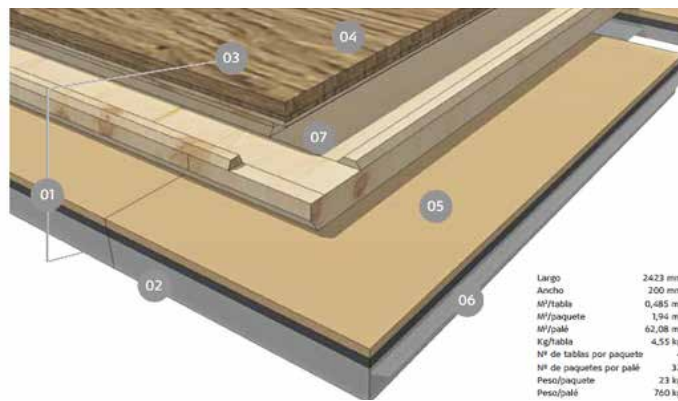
Revestimiento interior de piso en el Gimnasio, planta Alta +898.2 Activity Floor de AB K pfer. (2017)
